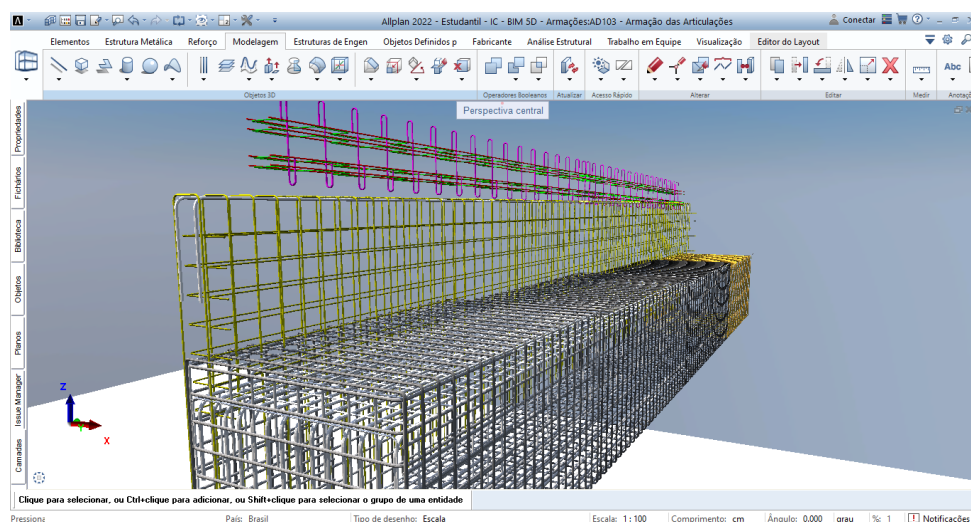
Vista isométrica realista das armações da travessa TR1.
